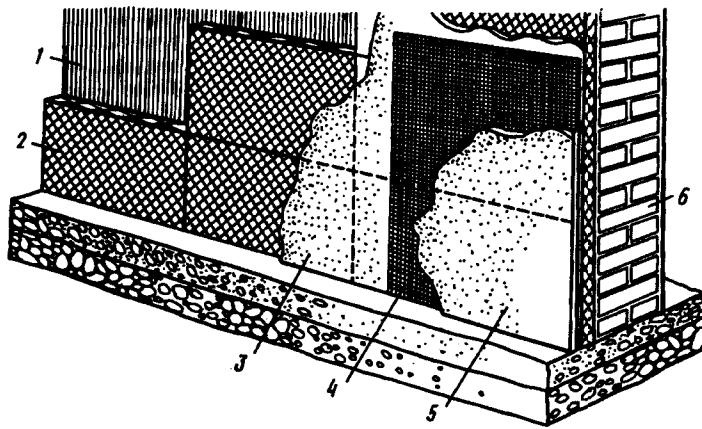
Утепление стен по существующей штукатурке теплоизоляционными плитками
